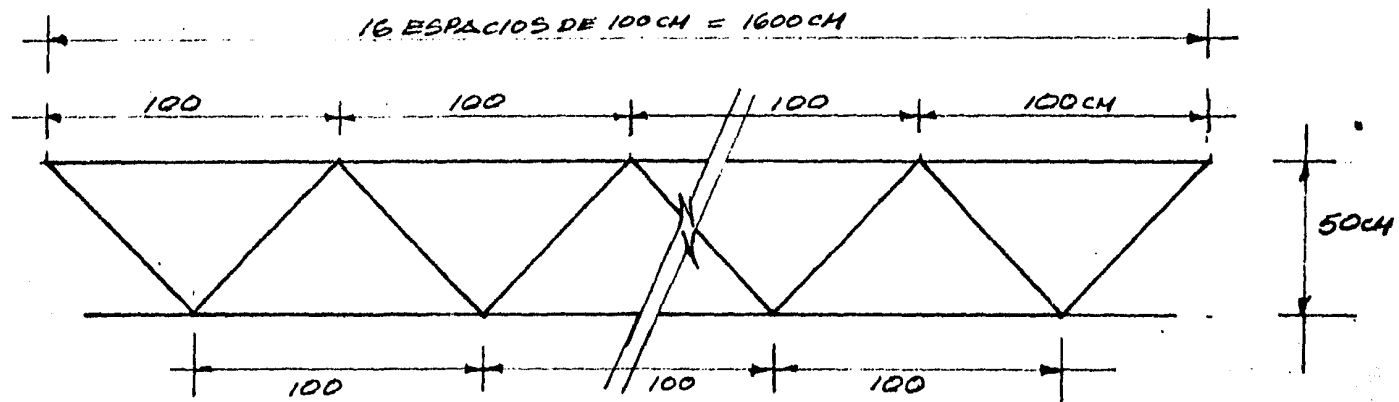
GEOMETRIA DE LA ARMADURA
